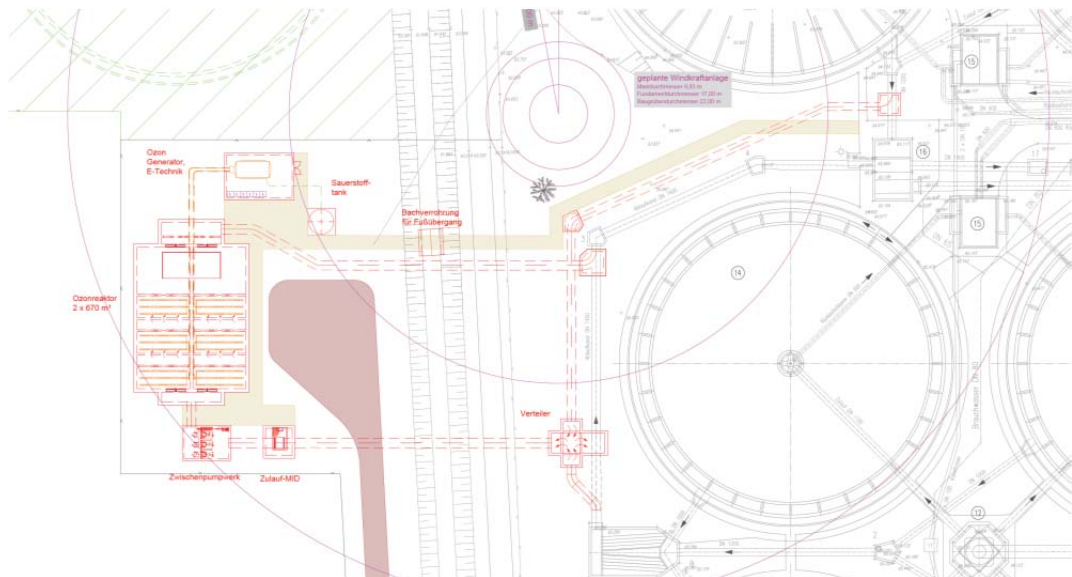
Lageplan Variante 3: Ozonierung
